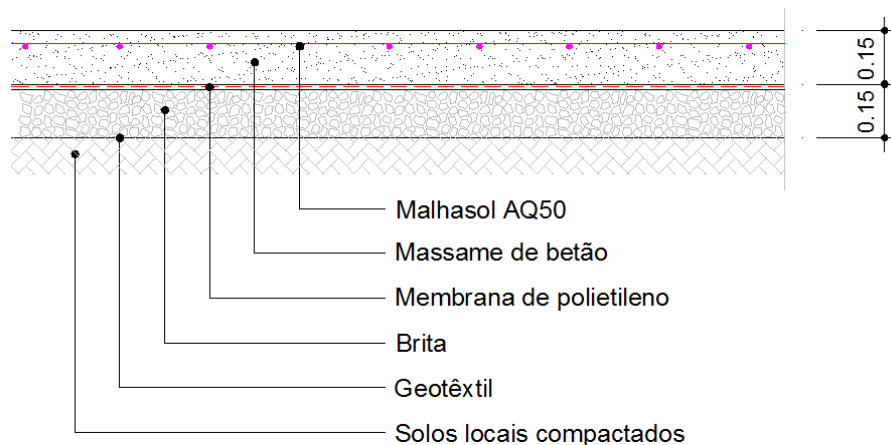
Constituição do pavimento térreo (adaptado de [42])
